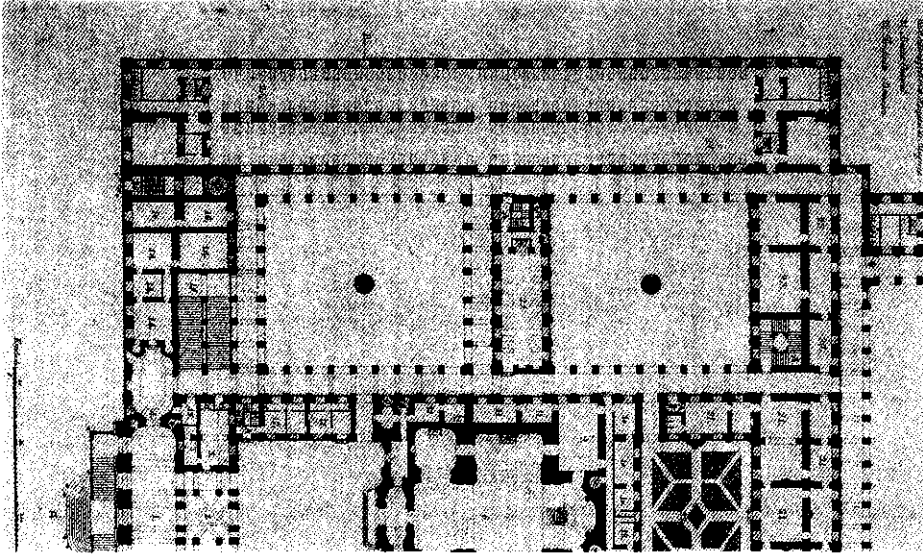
F. Sabatini. Hospital General. Detalle de la planta del piso bajo. AGP.
